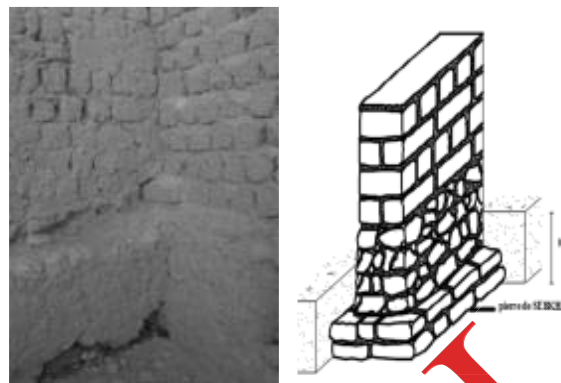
a et b : mur en adobe avec soubassement en pierre.
